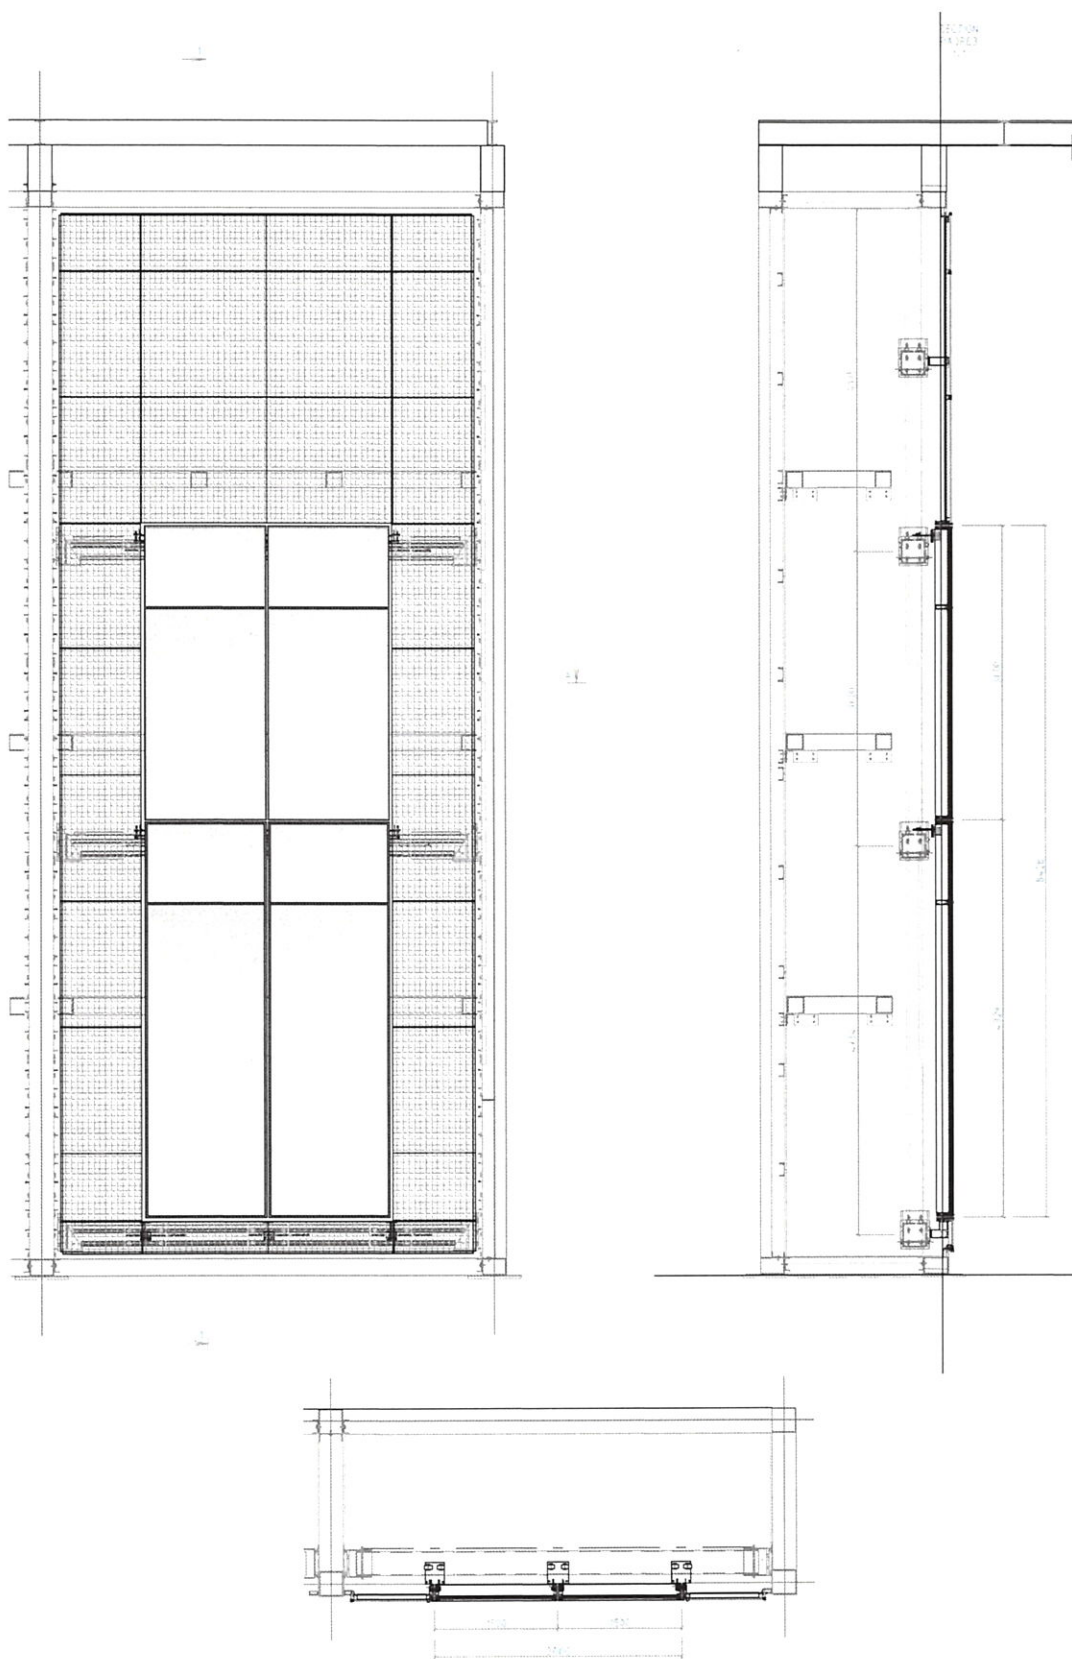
Общий вид образца 272-25-7 (со уличной стороны), характерный горизонтальный (внизу) и вертикальный (вверху) разрезы
